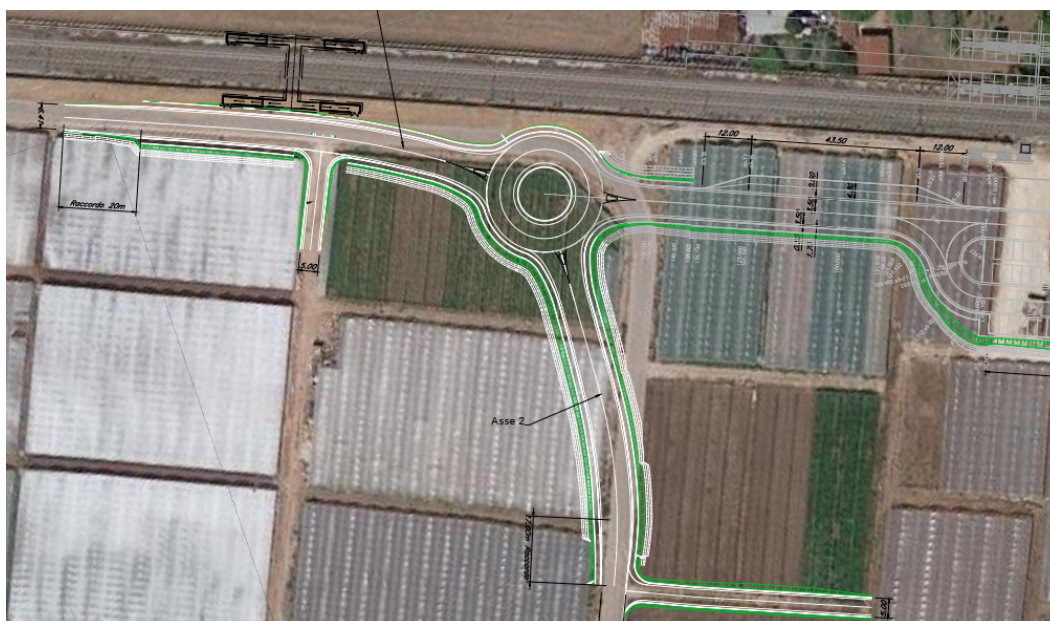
Stralcio planimetrico – NV05B_ Nuova rotatoria su strada locale e riprofilatura rami di innesto
